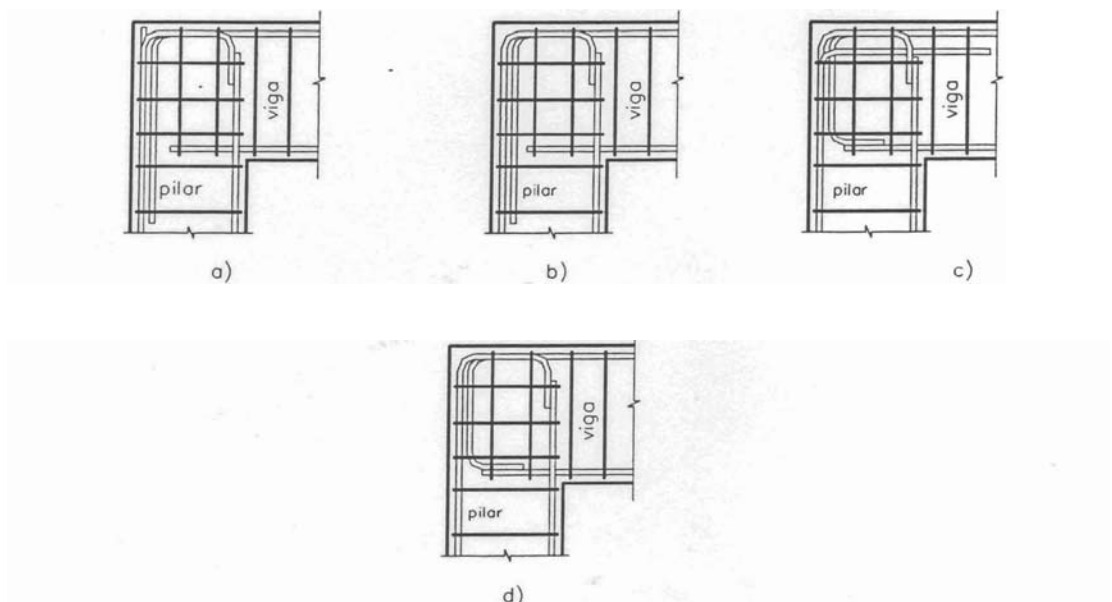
Detalhe de armadura de ligação viga de cobertura-pilar extremo dos modelos ensaiados por LUO et al. (1994)
